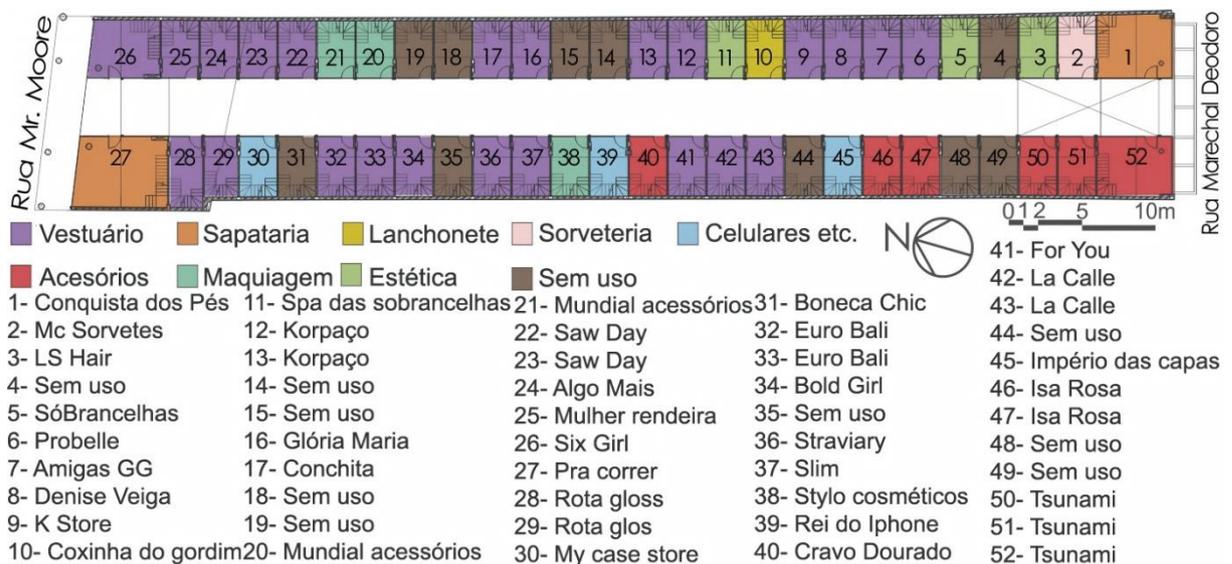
Marechal Shopping, planta baixa, levantamento dos usos da galeria
